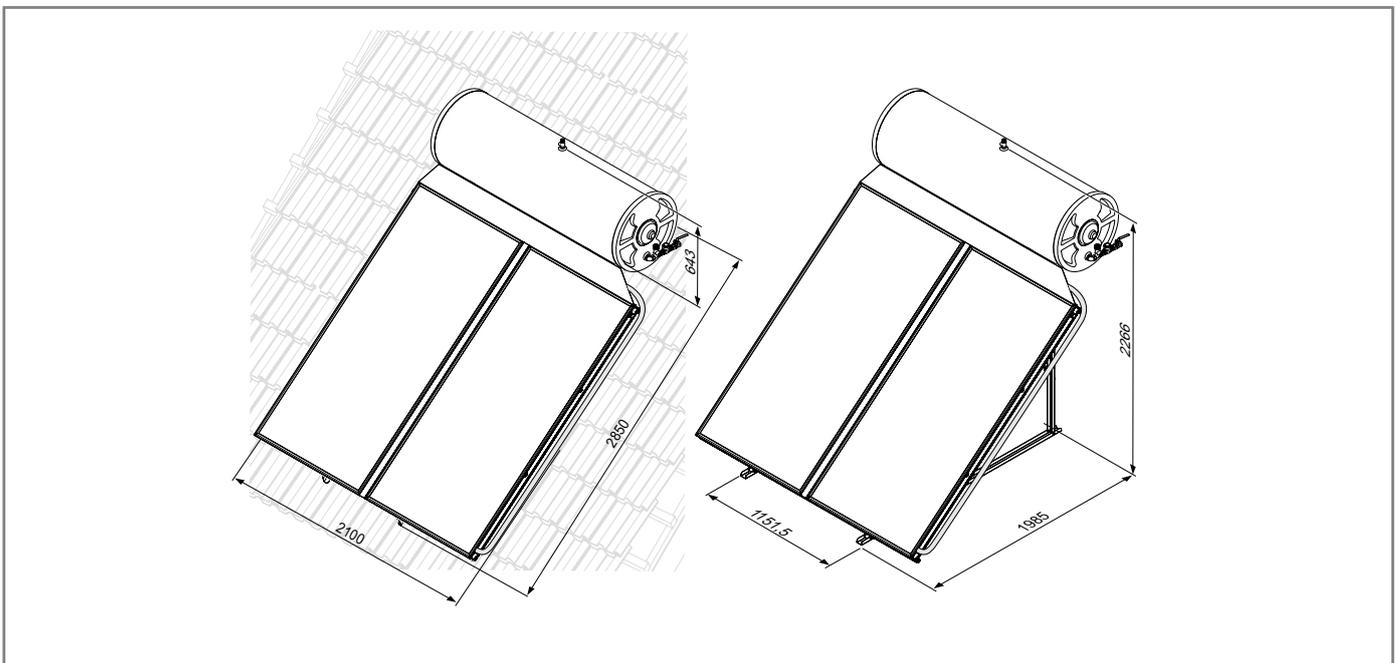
2-300 su tetto inclinato, 2-300 su tetto piano
